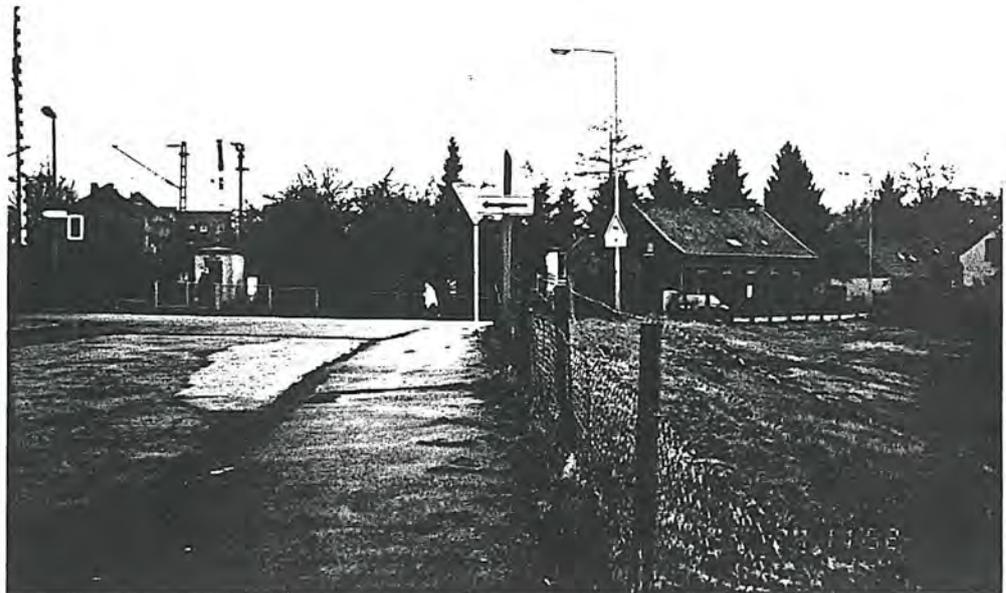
Blick von der Straße " der Brück" auf das Grundstück, welches für die westliche Brückenrampe des Kreuzungsbauwerks benötigt wird.
